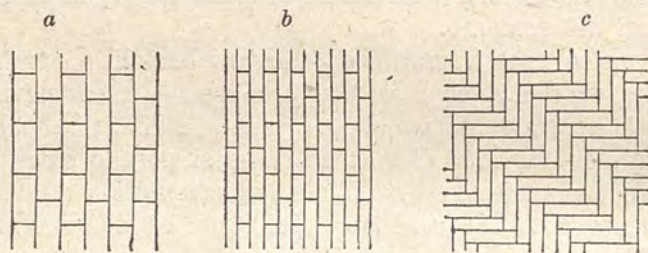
a, b, c. — Pavimenti di pianelle e mattoni in costa.
